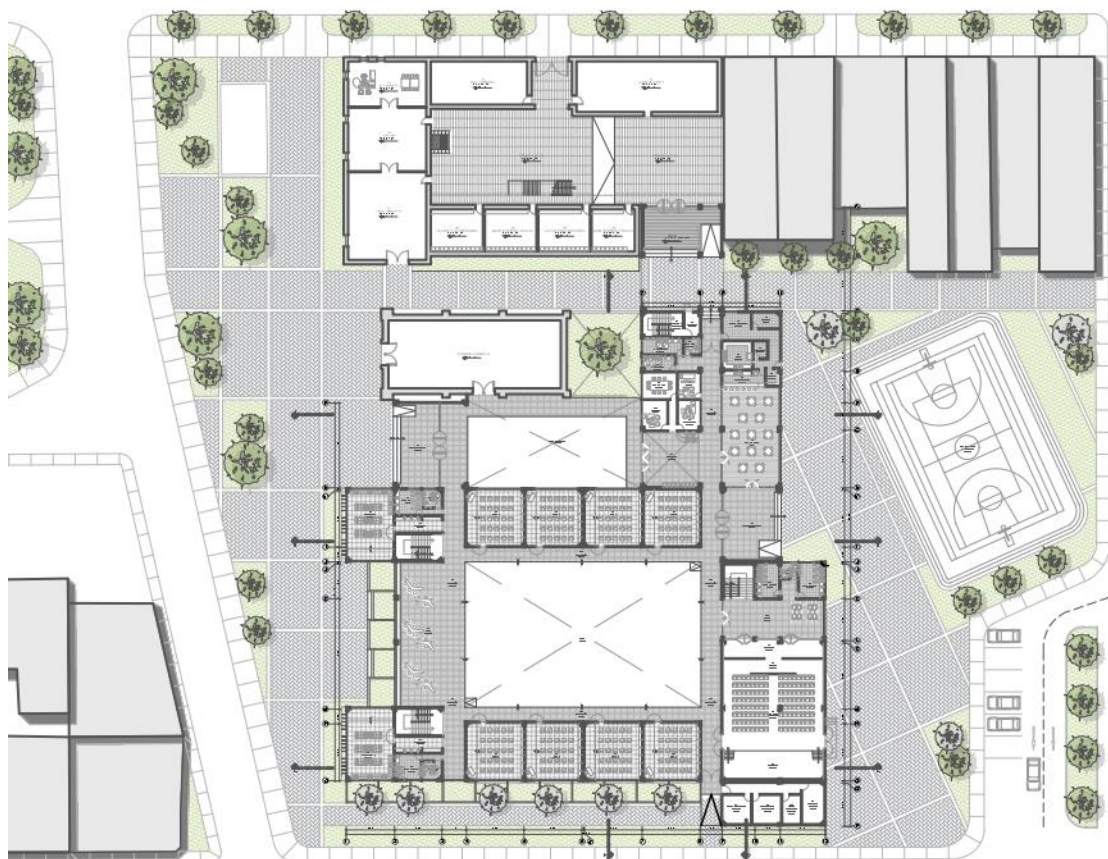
Plano primer nivel, propuesta arquitectónica Escuela Parroquial.
